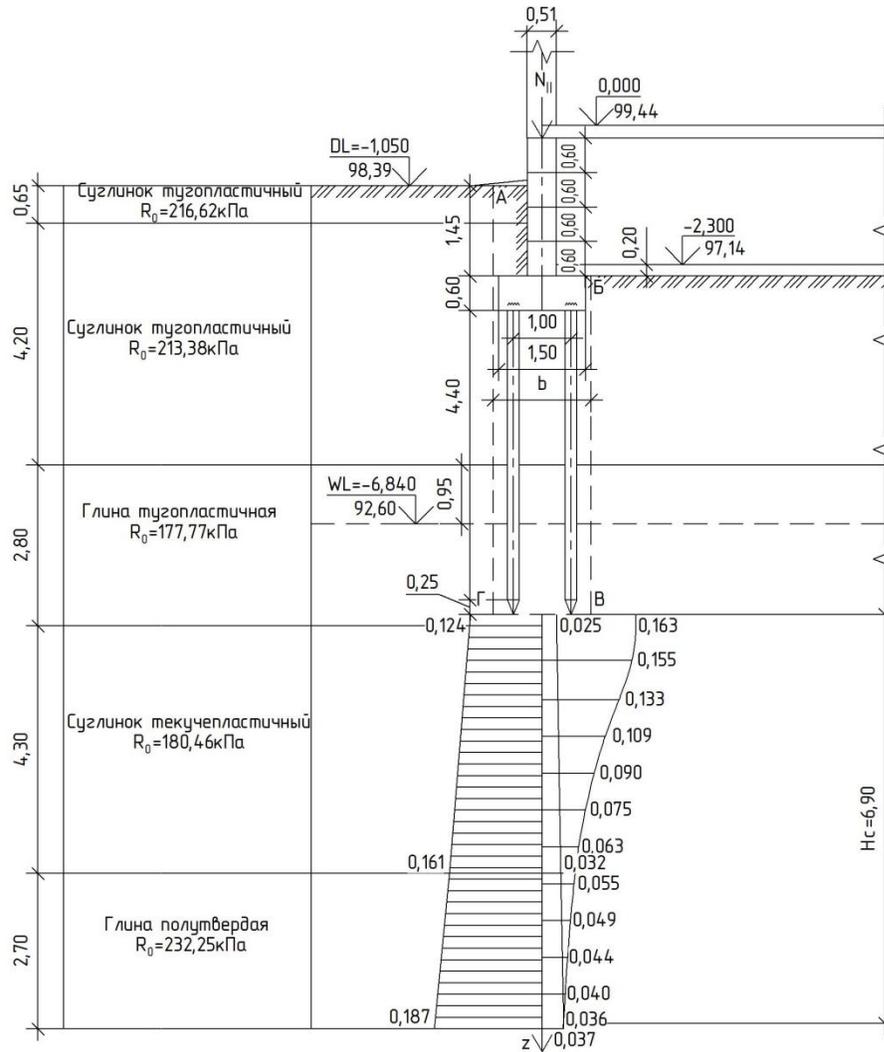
Схема к расчёту осадки по методу элементарного суммирования свайного фундамента
